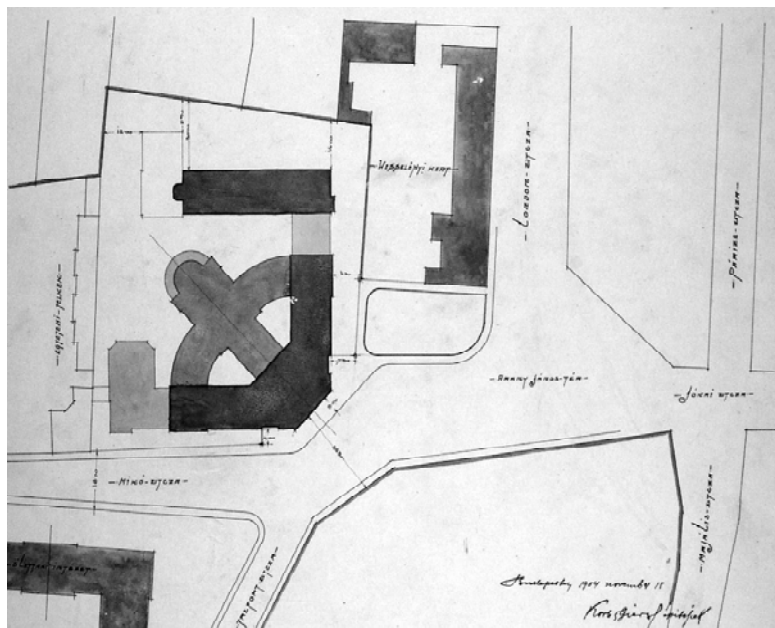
Planul de situație al proiectului de concurs, în varianta lui Korb și Giergl.
